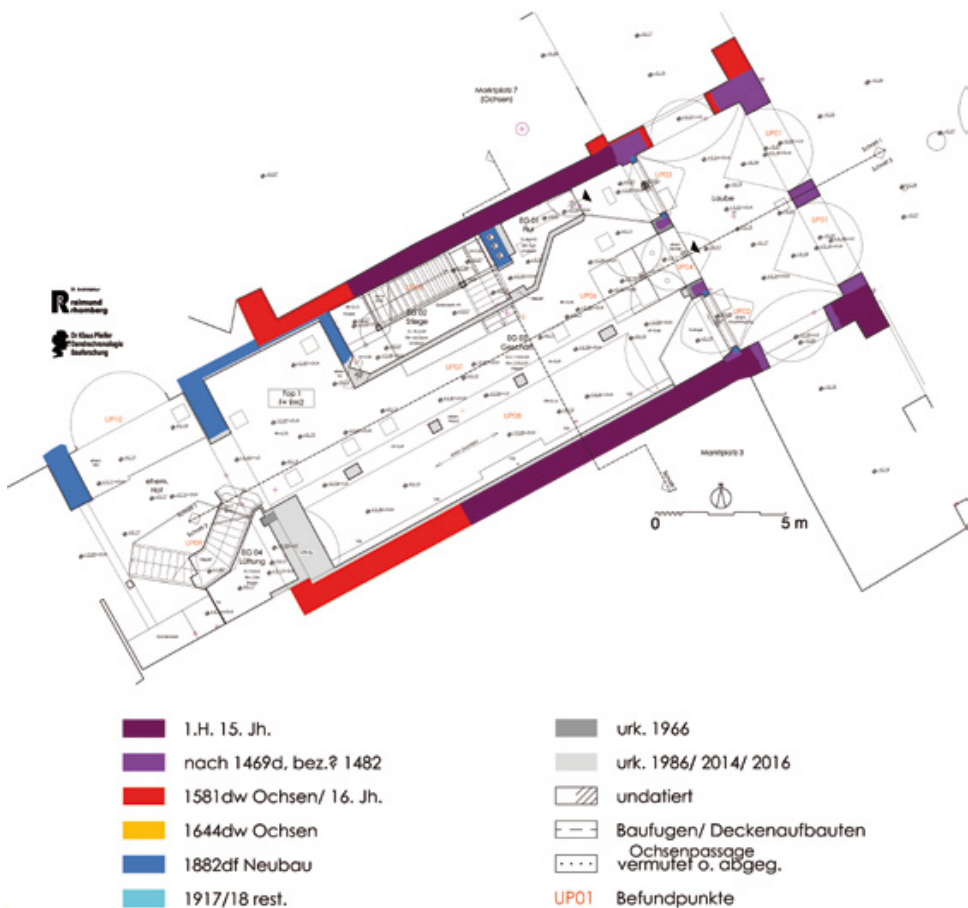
Feldkirch, Schülerhaus. Baualterplan des Erdgeschosses.
